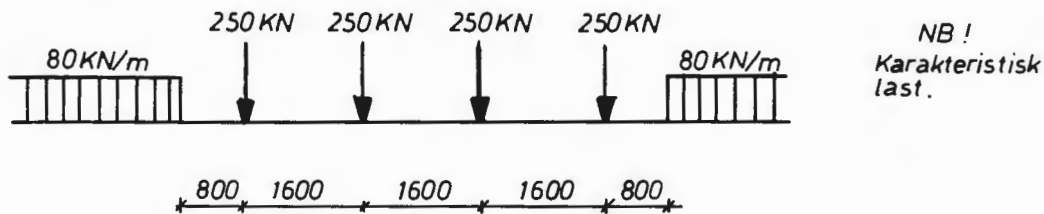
Dimensjonerende laster ved dobbeltspor.
